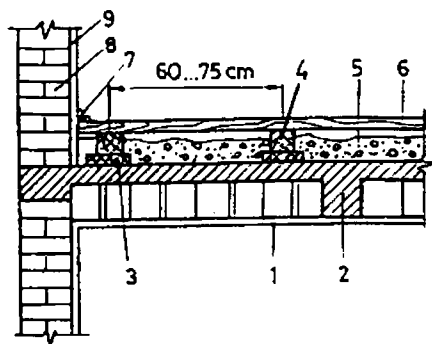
Montarea pardoselilor din lemn pe planșeu din beton armat:
